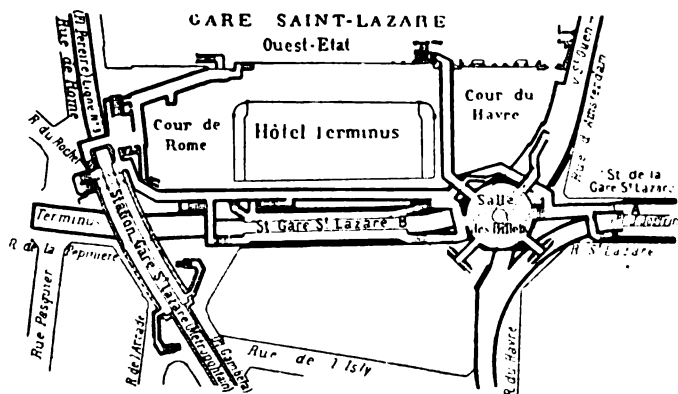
Stazione della Gare S. Lazare - Planimetria.
